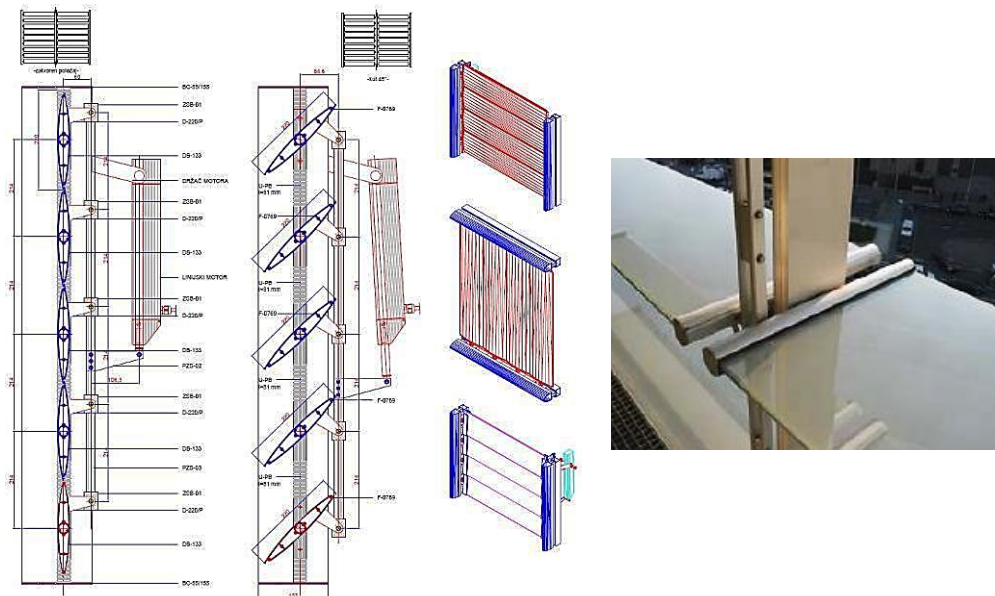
Fachada ventilada con hoja exterior formada por lamas
